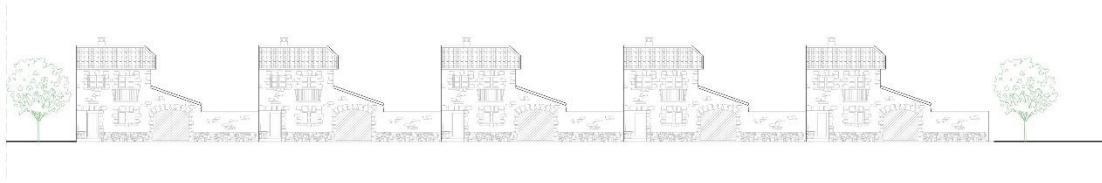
Alzados iniciales de Sodeto. Fuente: Elaboración propia.
